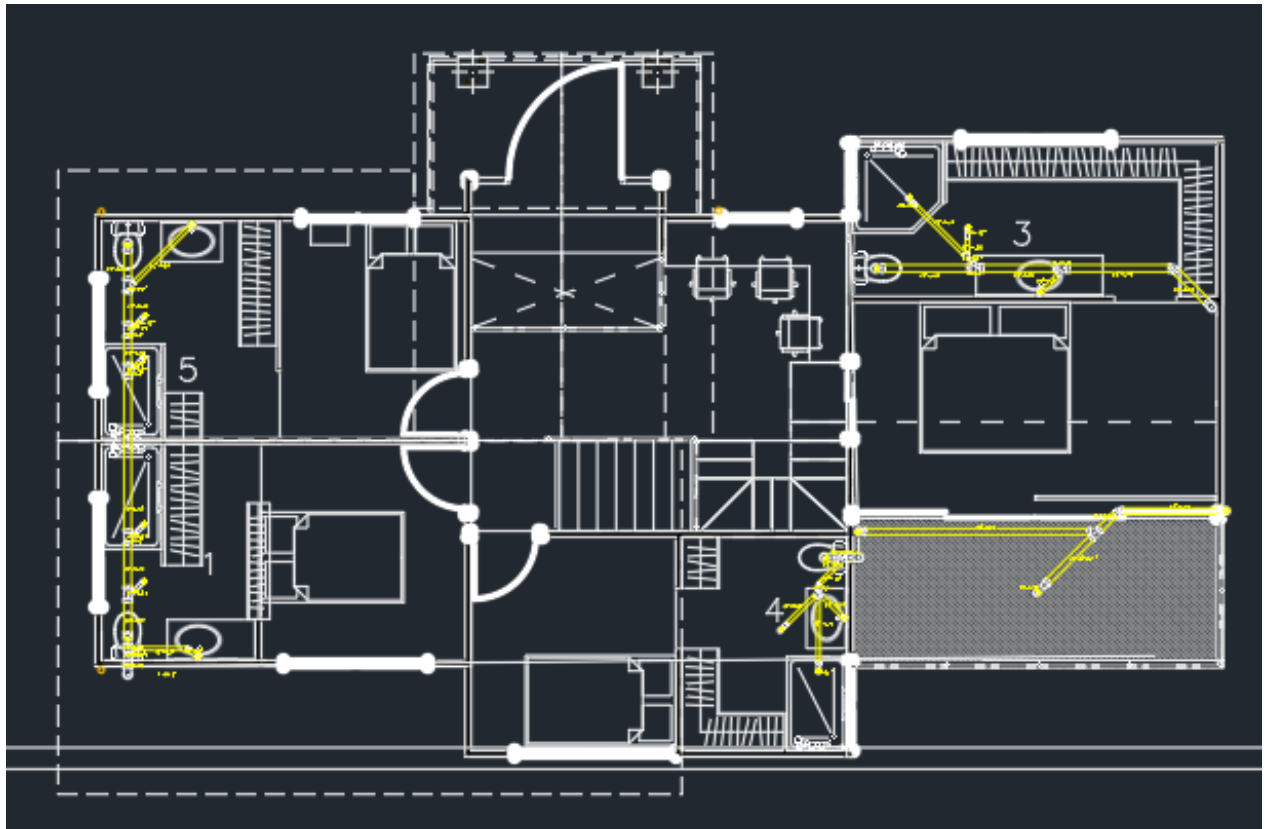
Diseño sanitario Planta 2 Casa Piedecuesta
